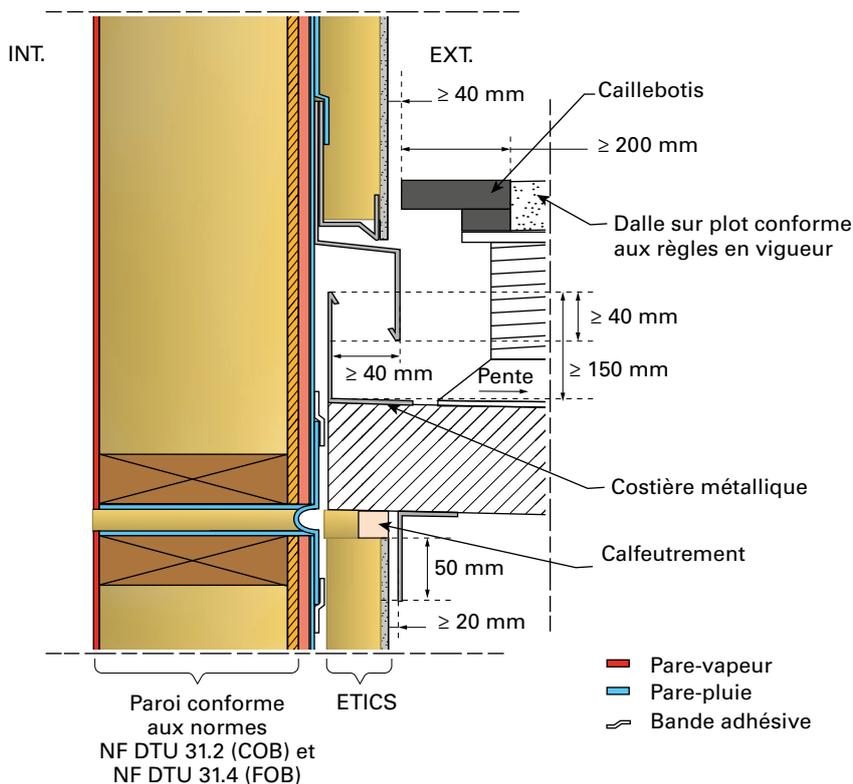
Exemple de traitement d'un balcon non directement circulable (au niveau d'un seuil de porte et d'une paroi opaque)
